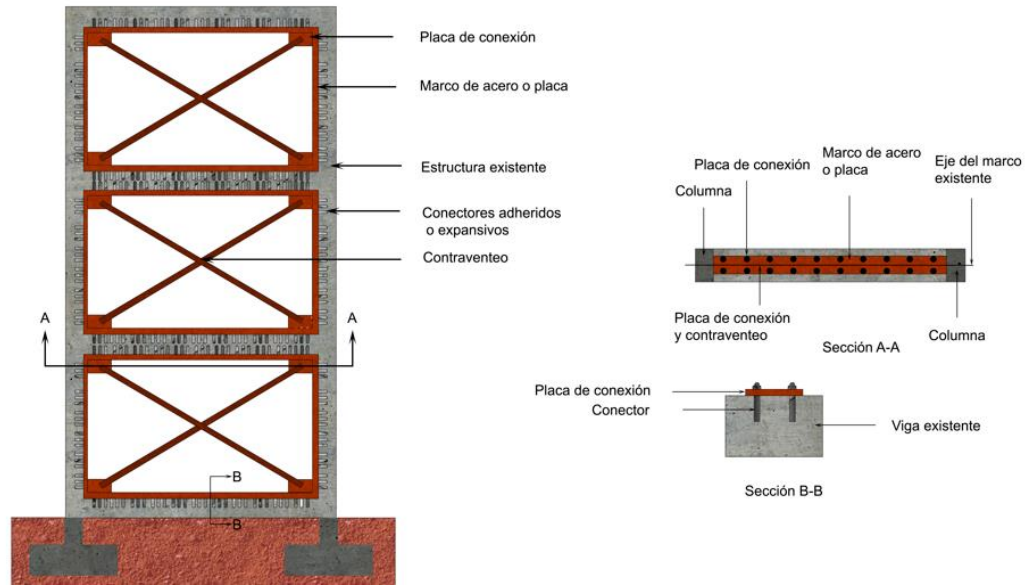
d – Contraventeo concéntrico en X conectado al marco existente por medio de un marco perimetral metálico (INIFED, 2021d)
